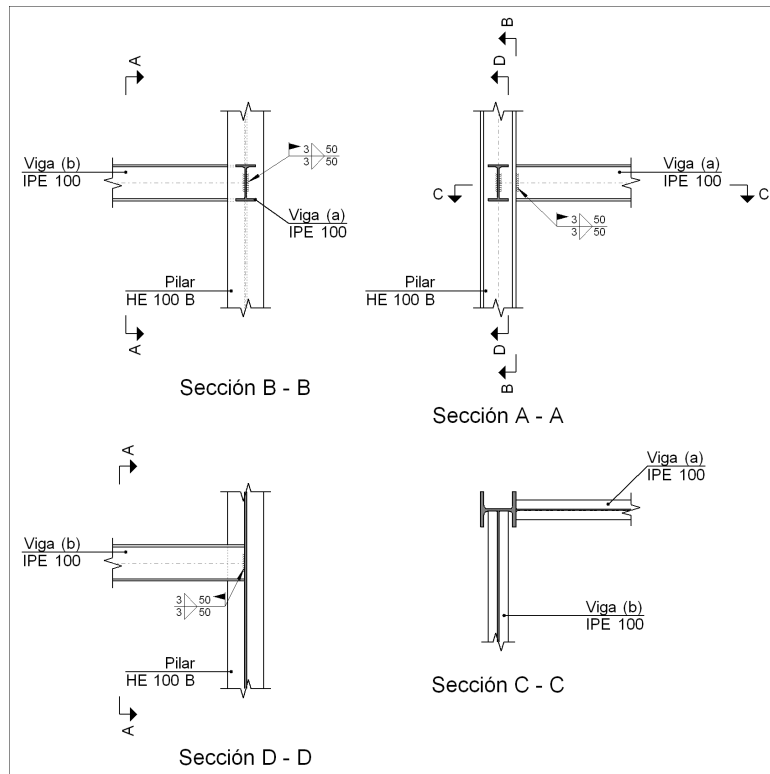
Detalle de las soldaduras tipo 3 de la estructura superior de las escaleras
